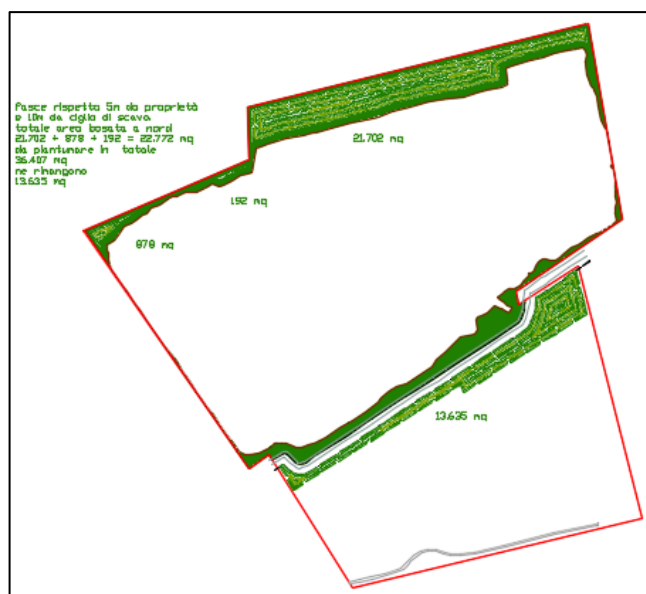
AREE OGGETTO DI PIANTUMAZIONE
